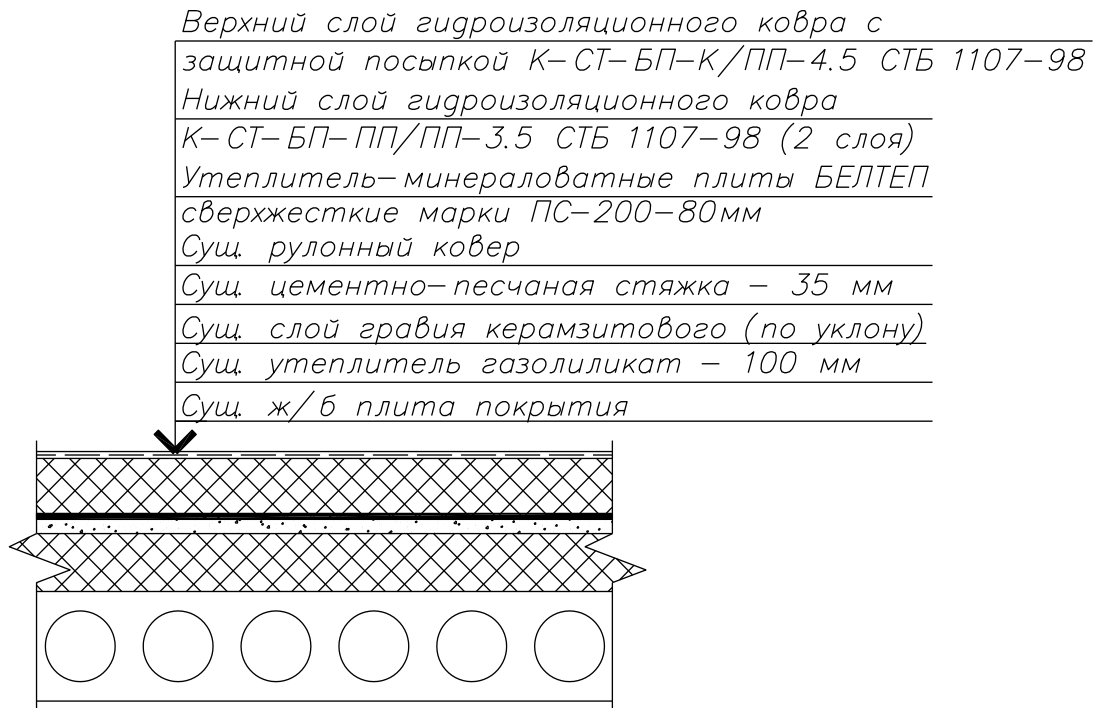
Конструктивное решение утепления существующей кровли
